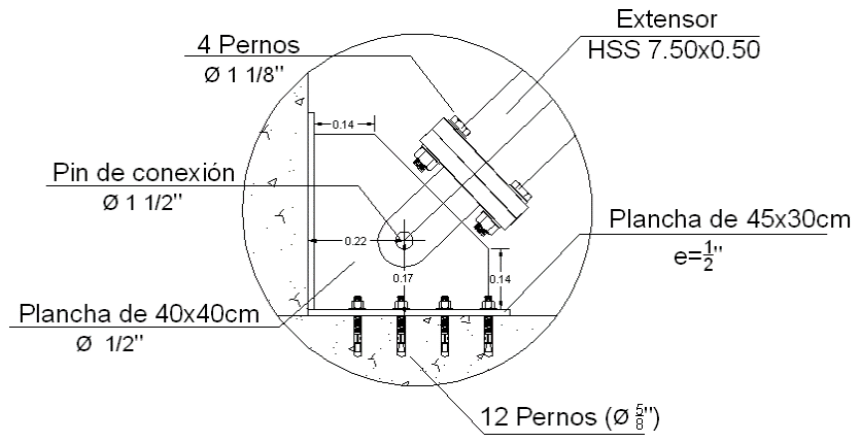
Detalle 1 (Conexión brazo metálico – Cartela - Estructura de concreto)
